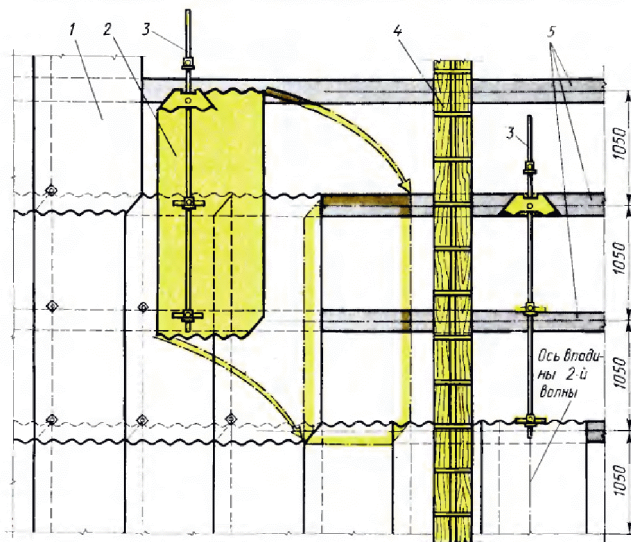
Разметка крепежных отверстий с помощью разбивочной рейки:
